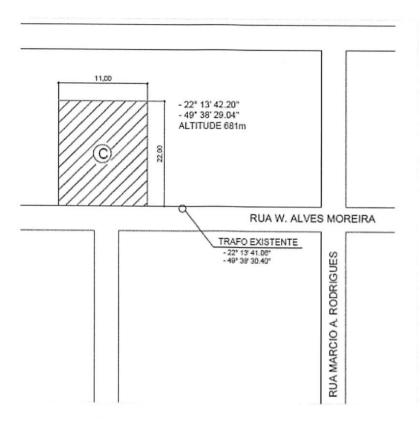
Croqui da área do terreno onde está localizado o Site GDWSP
